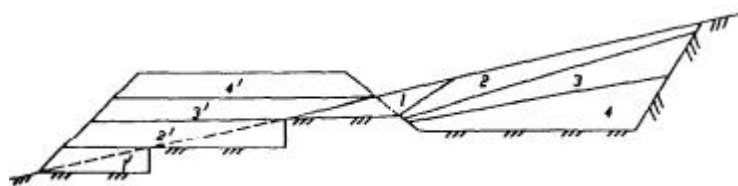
Последовательность отсыпки насыпи бульдозером путем поперечного перемещения грунтов:
